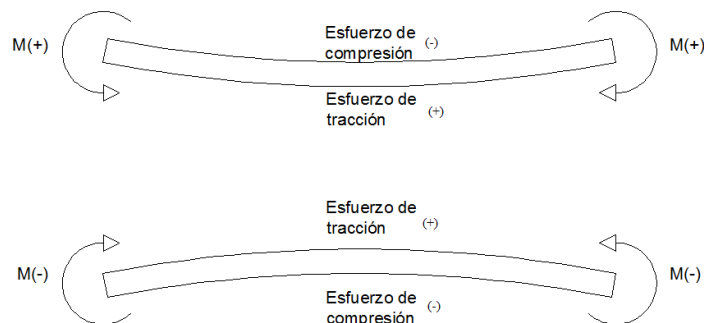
Distribución de los esfuerzos de compresión y tracción en losas de hormigón armado.
